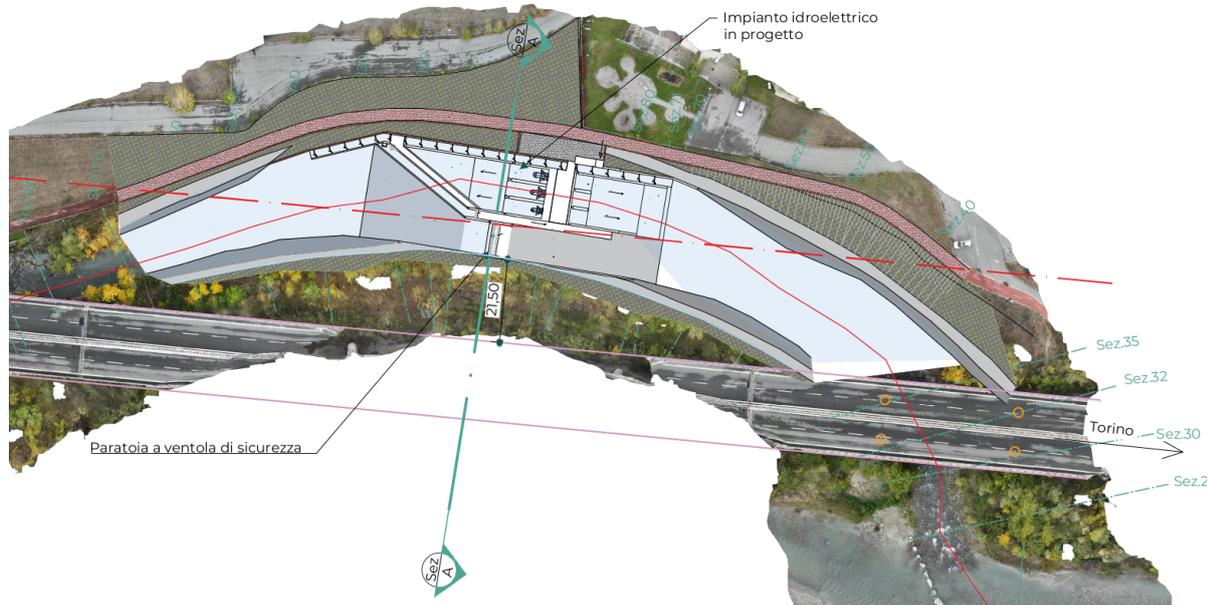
Vista planimetrica di progetto dell'impianto idroelettrico.
